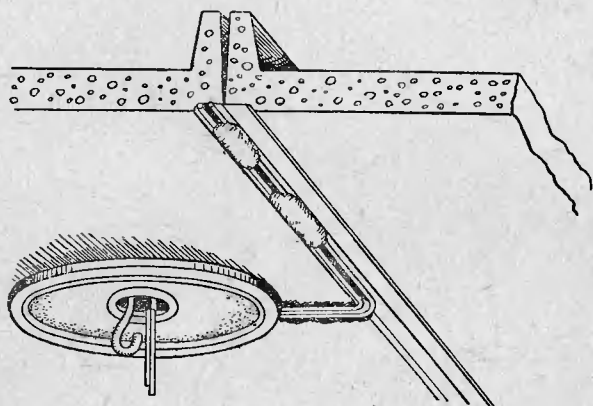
Прокладка провода по потолку из железобетонных плит.
